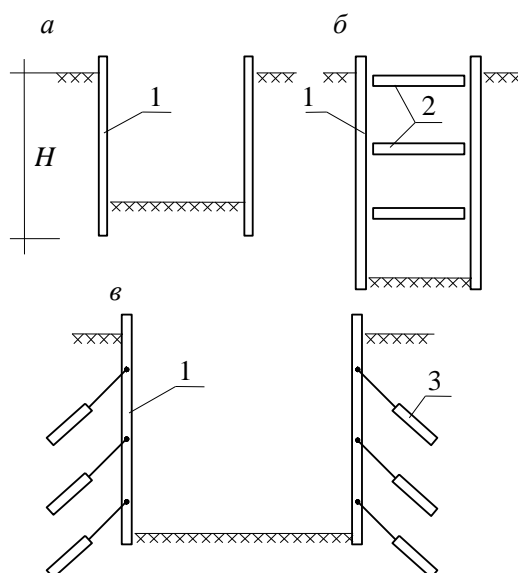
Конструктивні схеми споруд із паралельними стінами:
